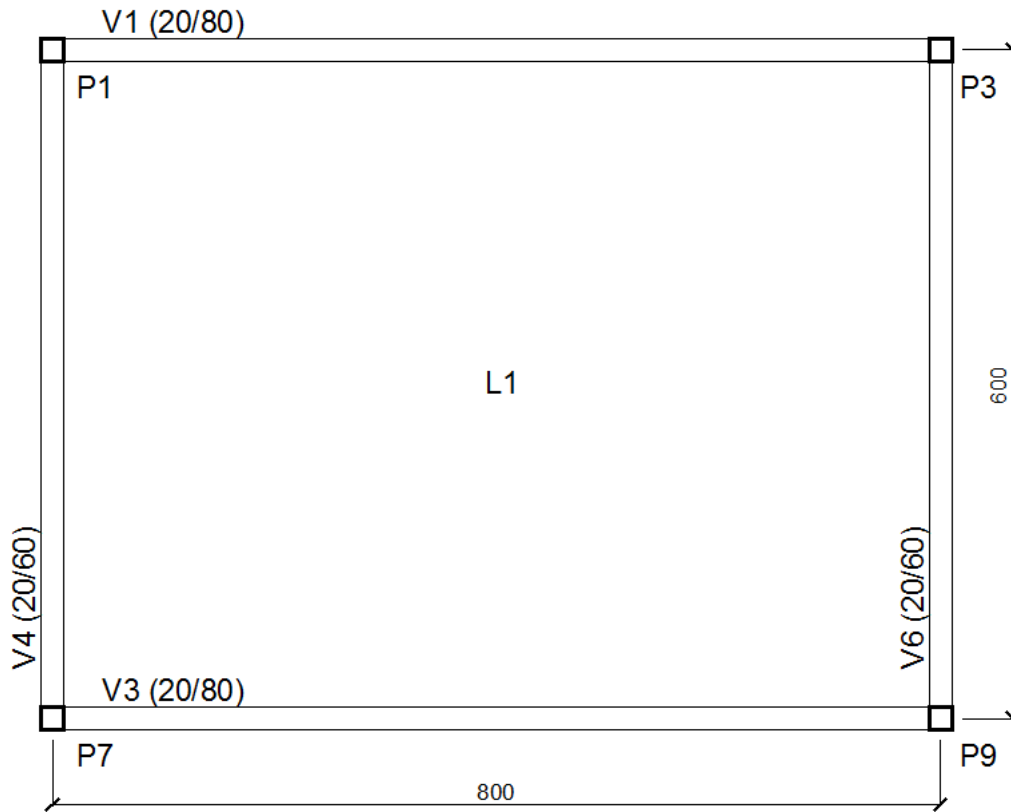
Exemplo 5 - Planta esquemática da forma do pavimento.
